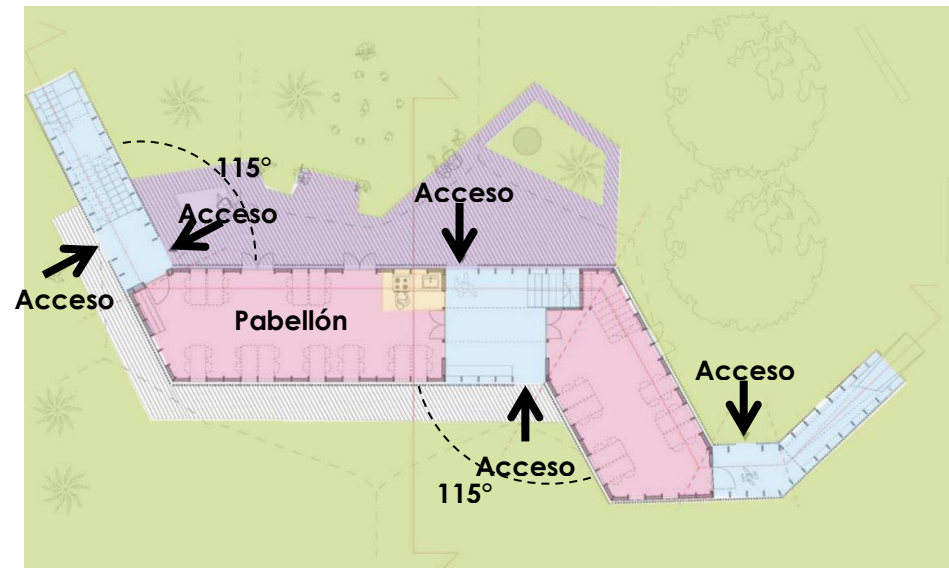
Planta baja centro comunitario en Pumanque
